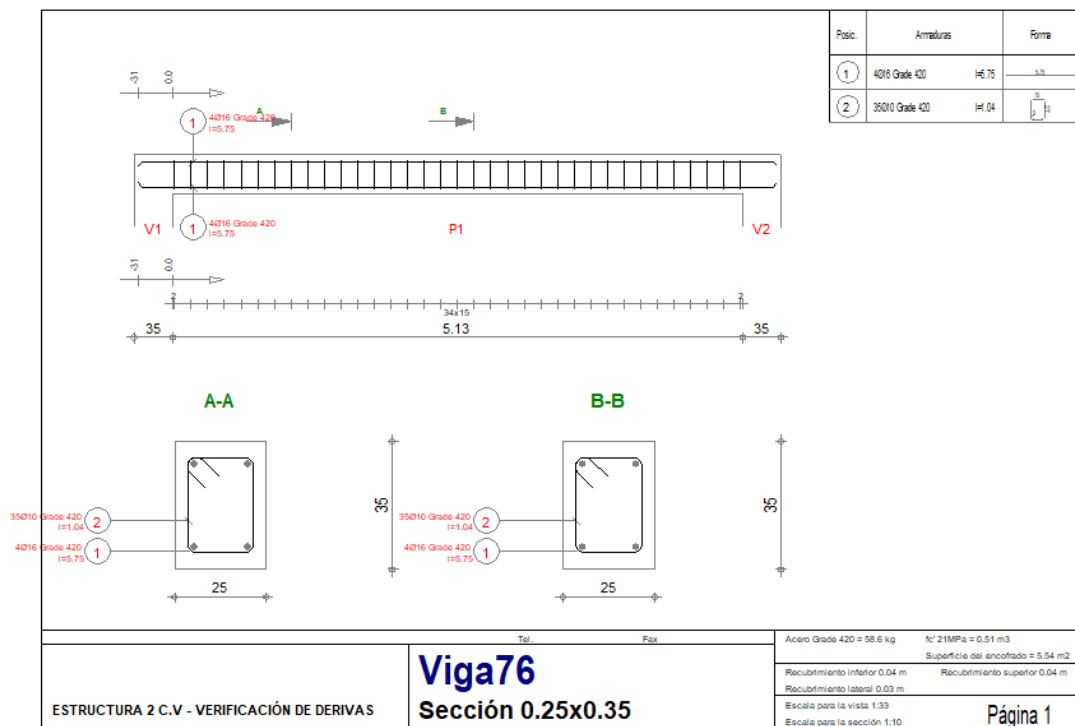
Despiece estructural de la viga 76 de la estructura 2 del Centro Vida.
